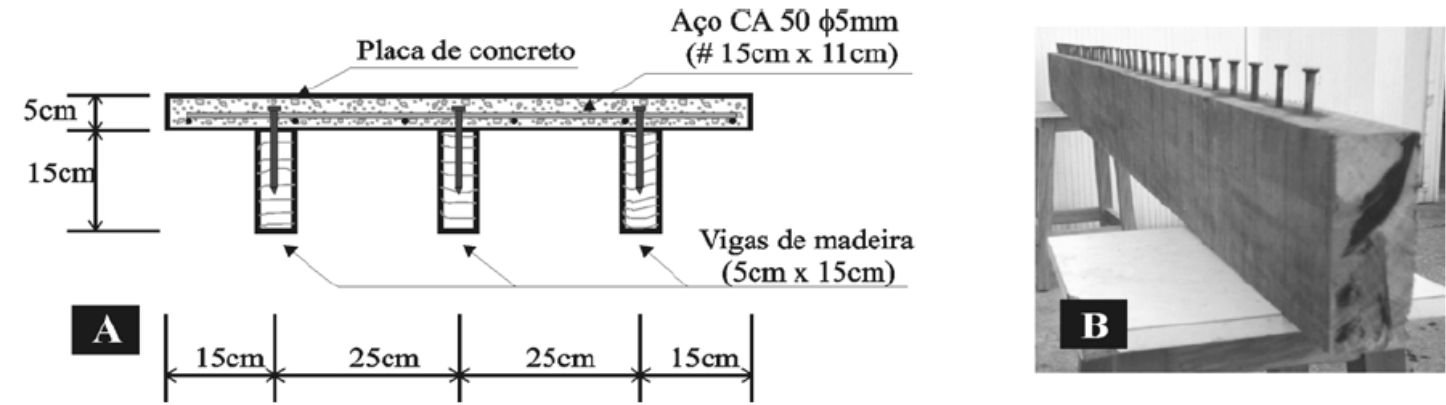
Seção transversal de painel misto em madeira-concreto com sistema de ligação discreta (A) e detalhe de conectores metálicos instalados verticalmente na viga de madeira (B).
